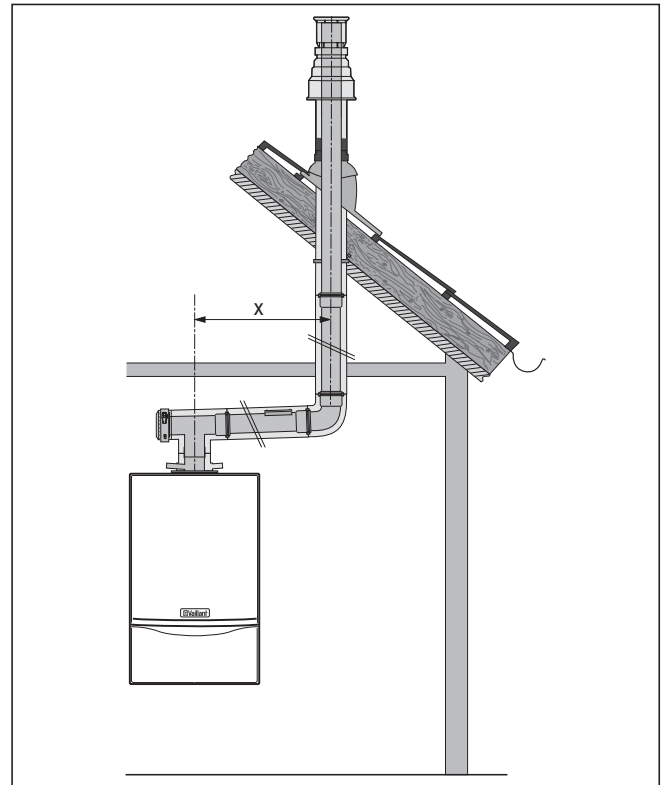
Esempio di montaggio: passante verticale a tetto
